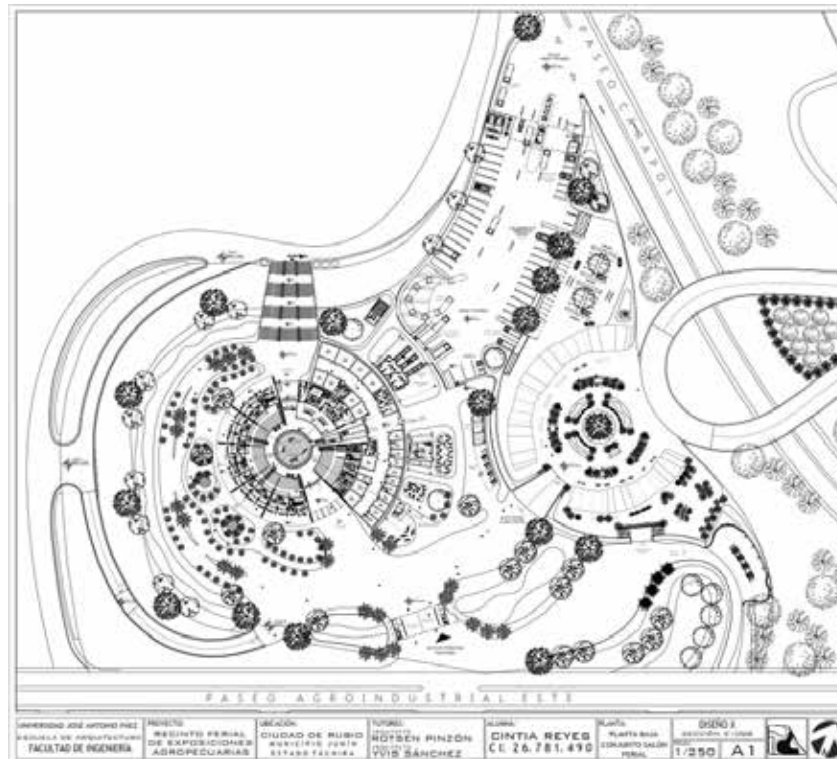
Plano A1, Planta baja conjunto del salón ferial. La Autora (2020).
